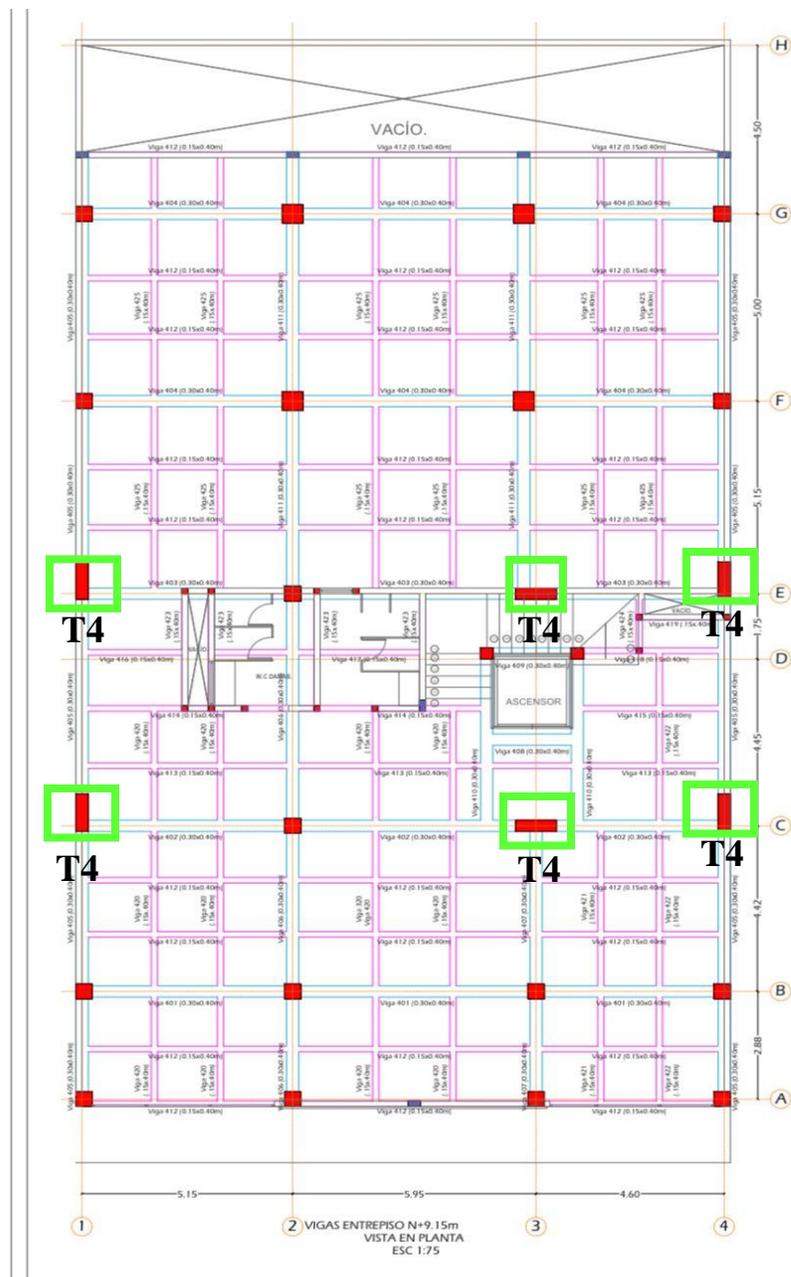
Vigas, columnas y columnetas vista de planta.
